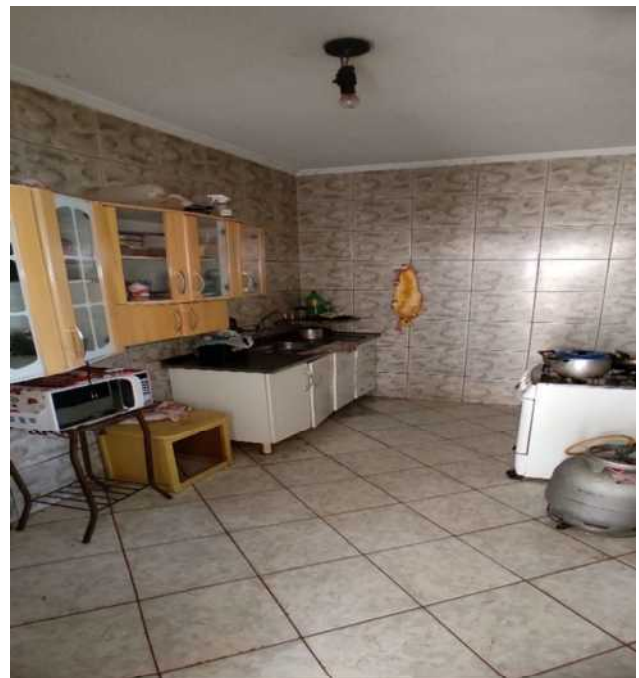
Cozinha em Piso ceramico, acabamento ceramico até o teto, Laje premoldada concreto, sanca em gesso e Pintura Latex
